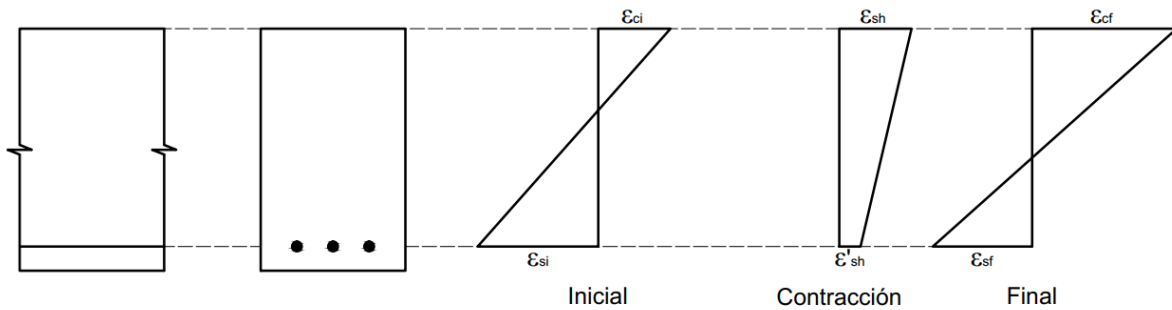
Deformaciones por contracción en vigas simplemente armadas.
